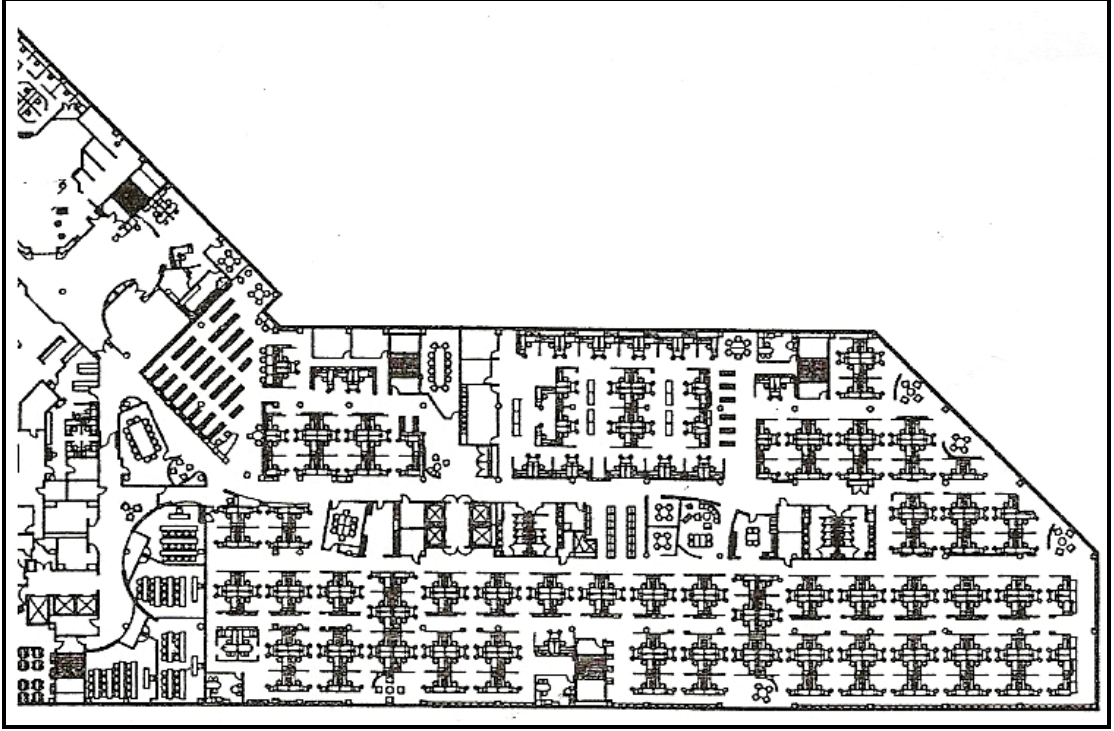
9 Açık ve serbest düzenli plan tipleri [6]
